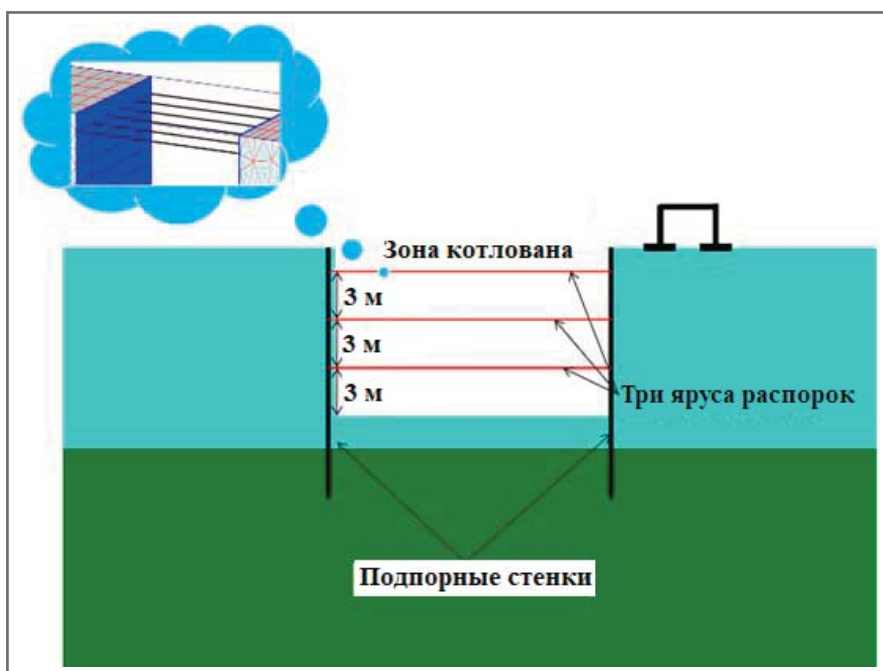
Схематический вертикальный разрез котлована с системой горизонтальных распорок для поддержки подпорных стенок [7]
